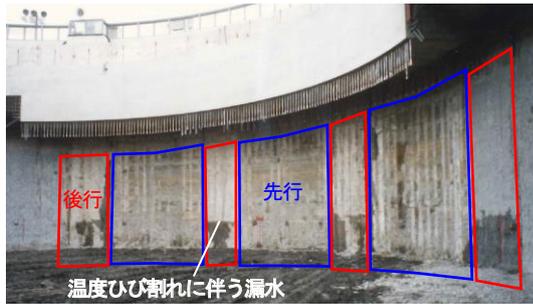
ひび割れに伴う漏水の発生状況 (事例)
